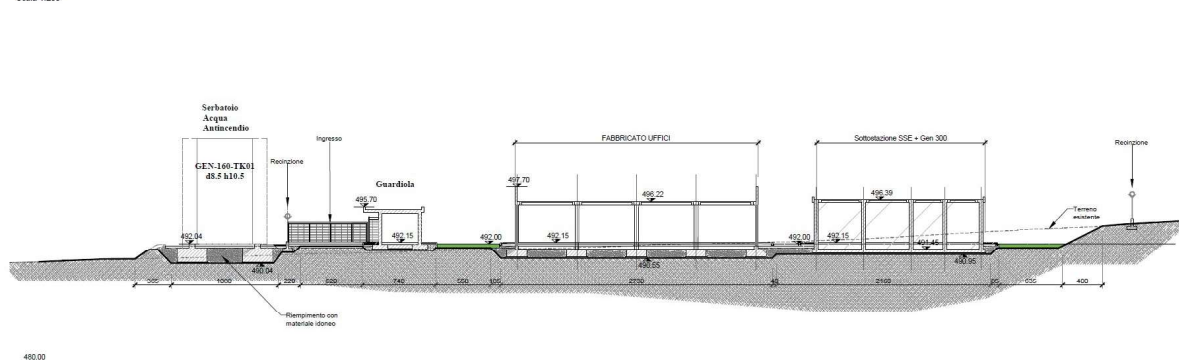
Sezioni A-A e B-B relative a planimetria di Tab. 3
